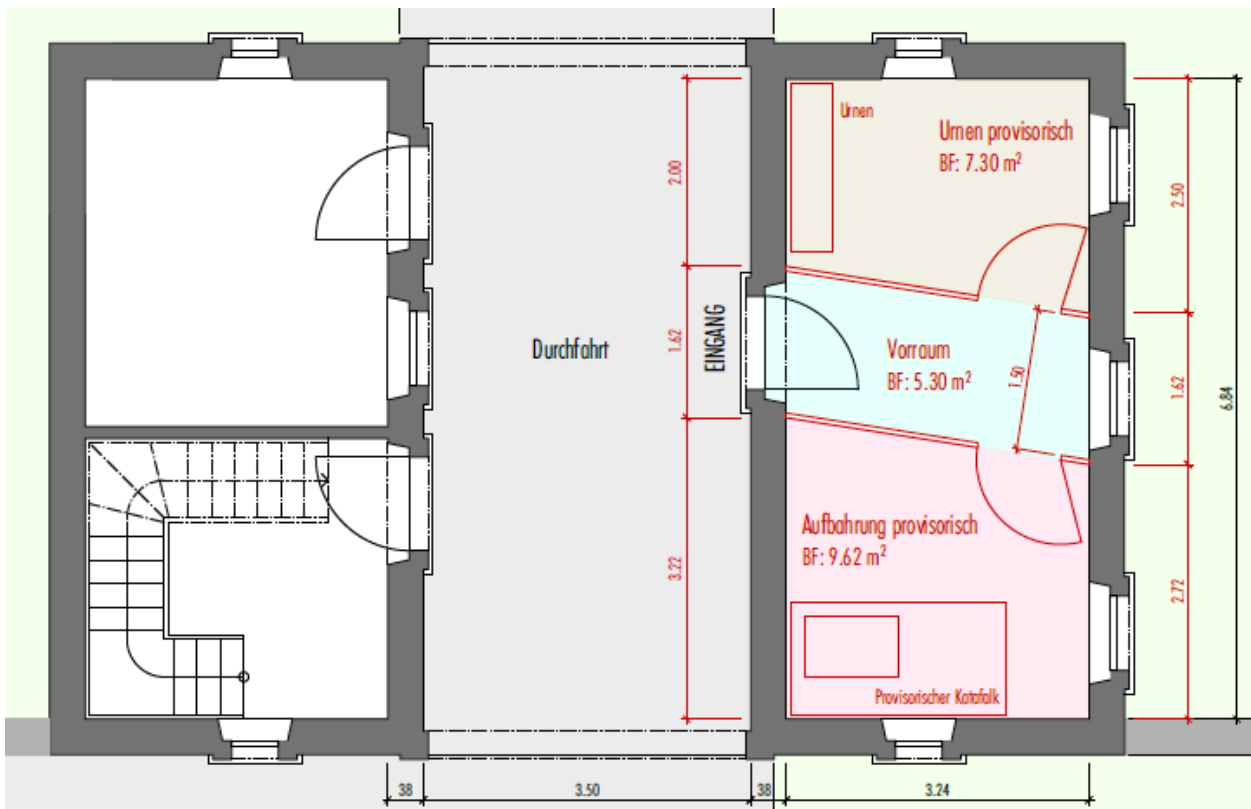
; Plan Provisorium alte Aufbahnhalle
